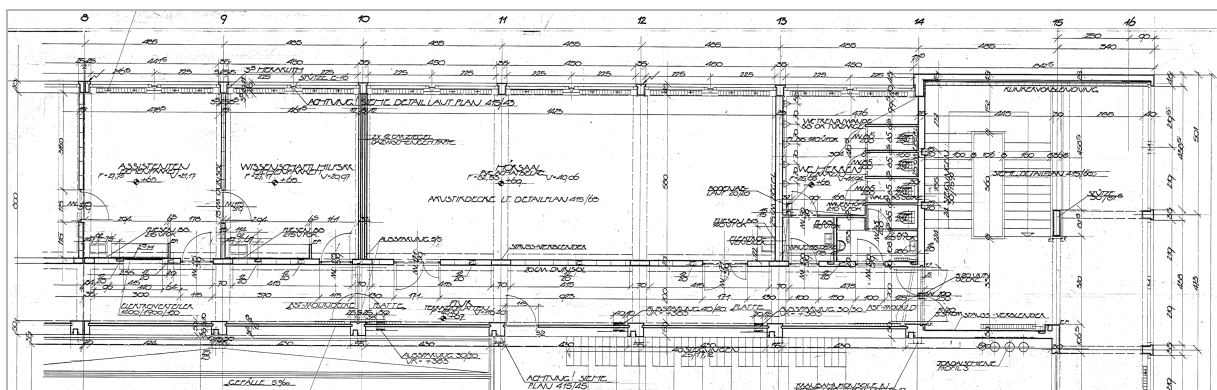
Darstellung des Grundrisses des Erdgeschosses des Wasserbaulabors in der Stremayrgasse 10 – Abschnitt 8-16 (Original Planscans aus dem Jahr 1961)
